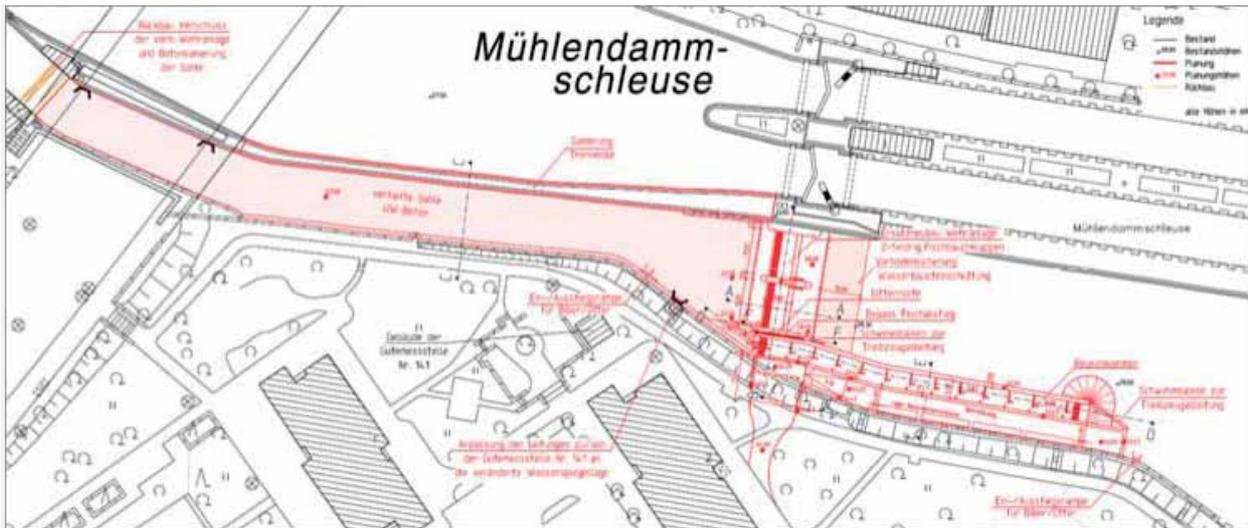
Entwurf Mühlendamm-schleuse (WNA, abgestimmte Vorzugsvariante 08.2018)
